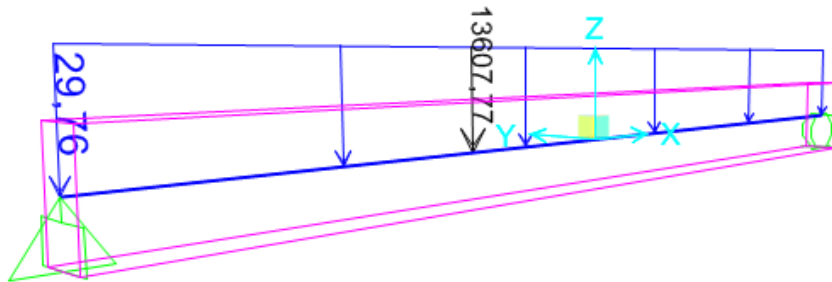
Modelo Beam de la Viga 2 en SAP2000. Fuente: Autor.
